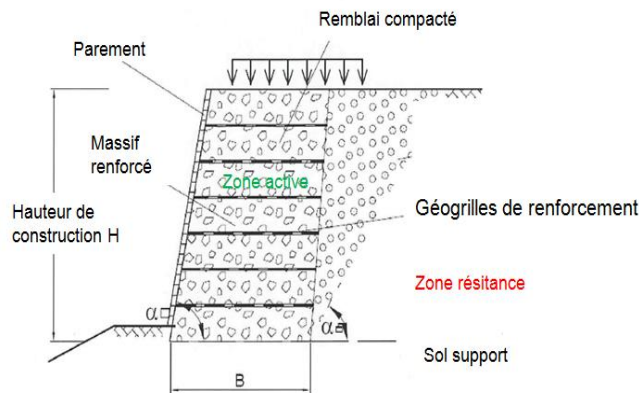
Coupe transversale d'un ouvrage de soutènement en sol renforcé par des géogrilles
